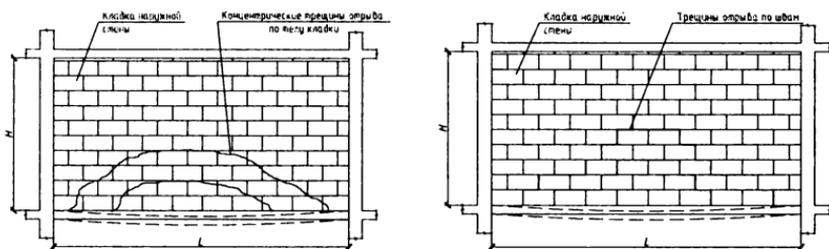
Характер трещинообразования в кирпичной кладке при прогибе плиты перекрытия
